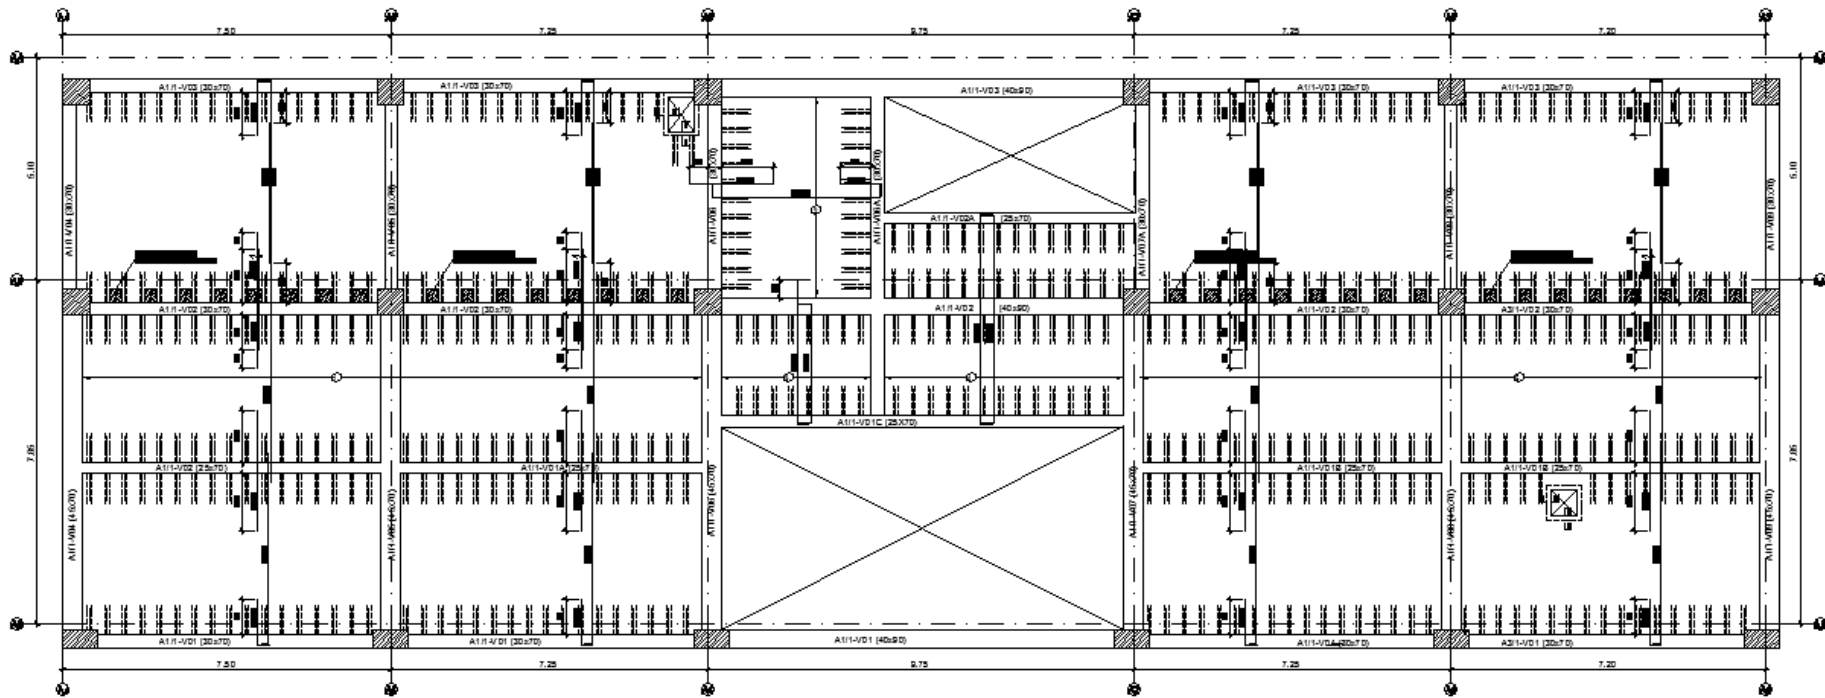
Encofrado Estructura Aislada (Fuente propia).
